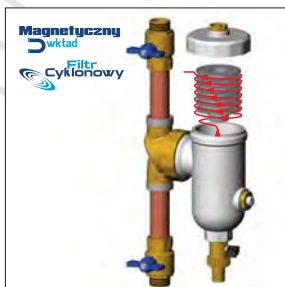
Prawidłowy montaż: w systemach ogólnych
